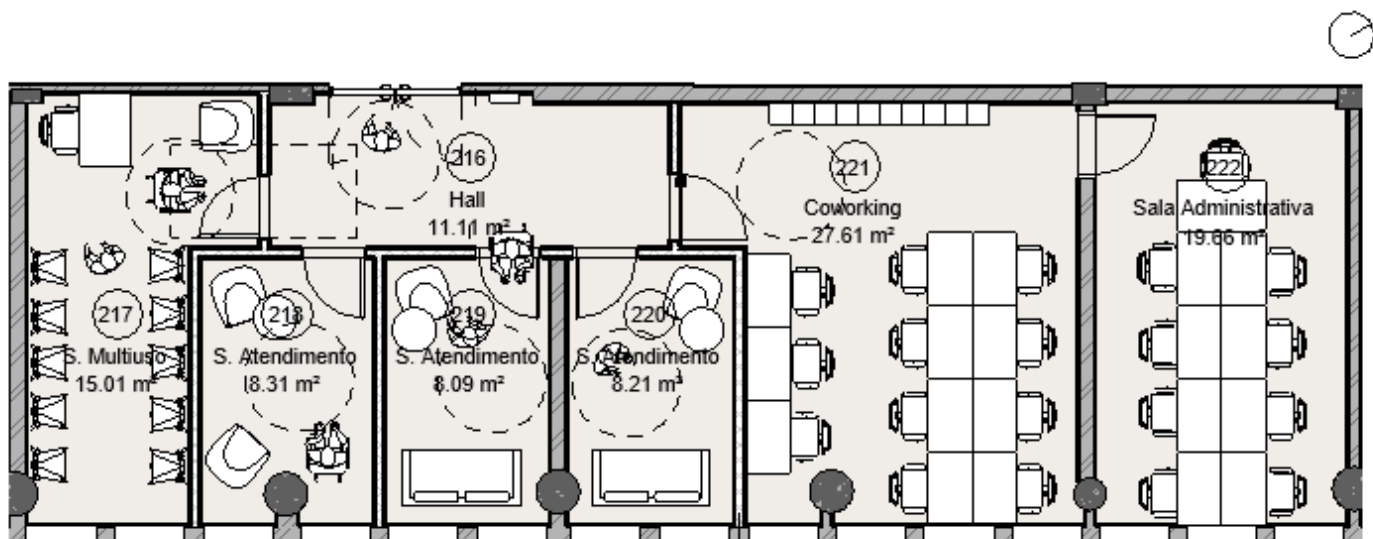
planta baixa com layout das salas 216, 217, 218 e 219 novo espaço PRAE
